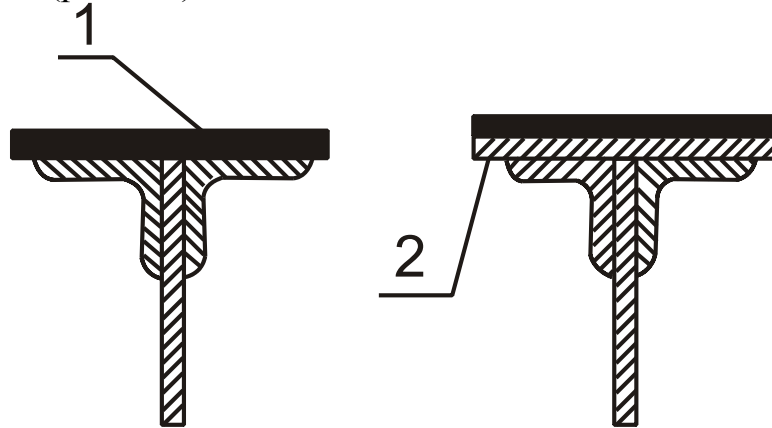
Схемы усиления балок проезжей части сплошным листом: 1 – лист; 2 – уплотненный зазор
